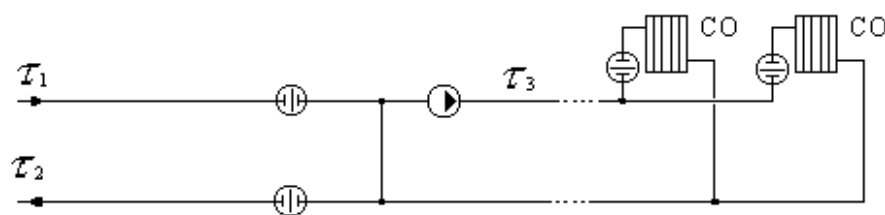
Схема ЦТП (ИТП) с насосом смешения на подающем трубопроводе
